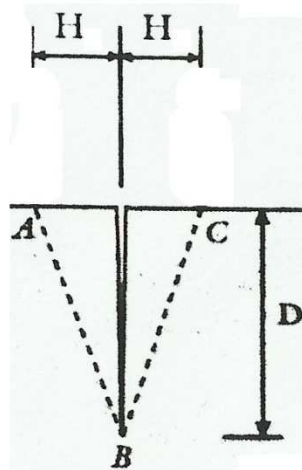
Schema della geometria della prova (Sansalone e Streett, 1997).
